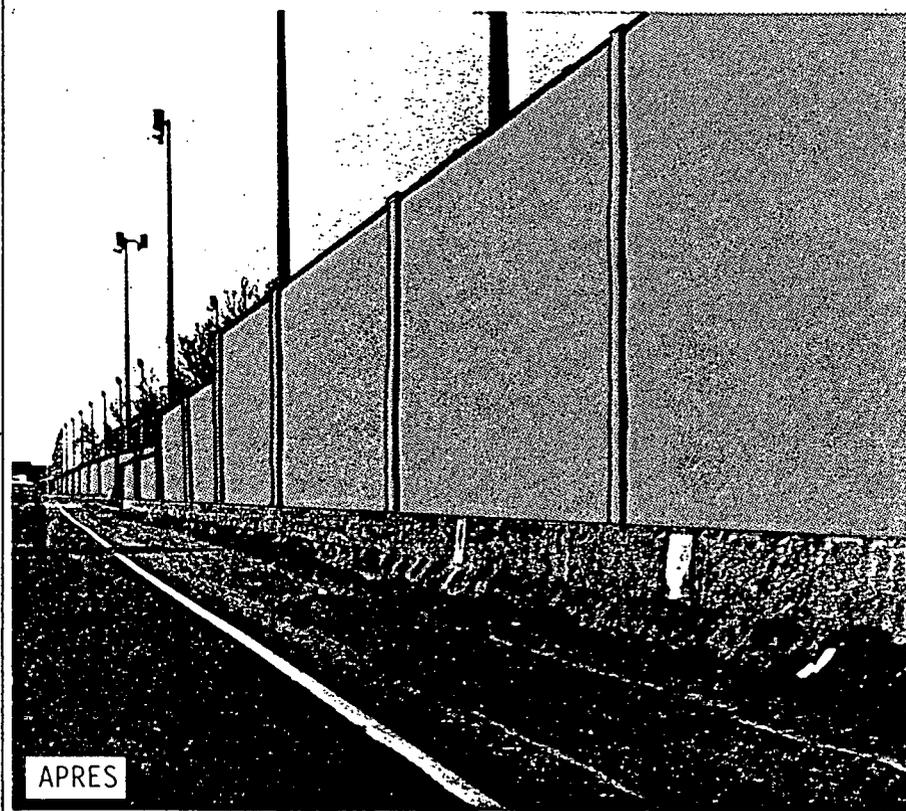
VUE DE L'AUTOROUTE, A LA HAUTEUR DE L'AVENUE ATWATER
